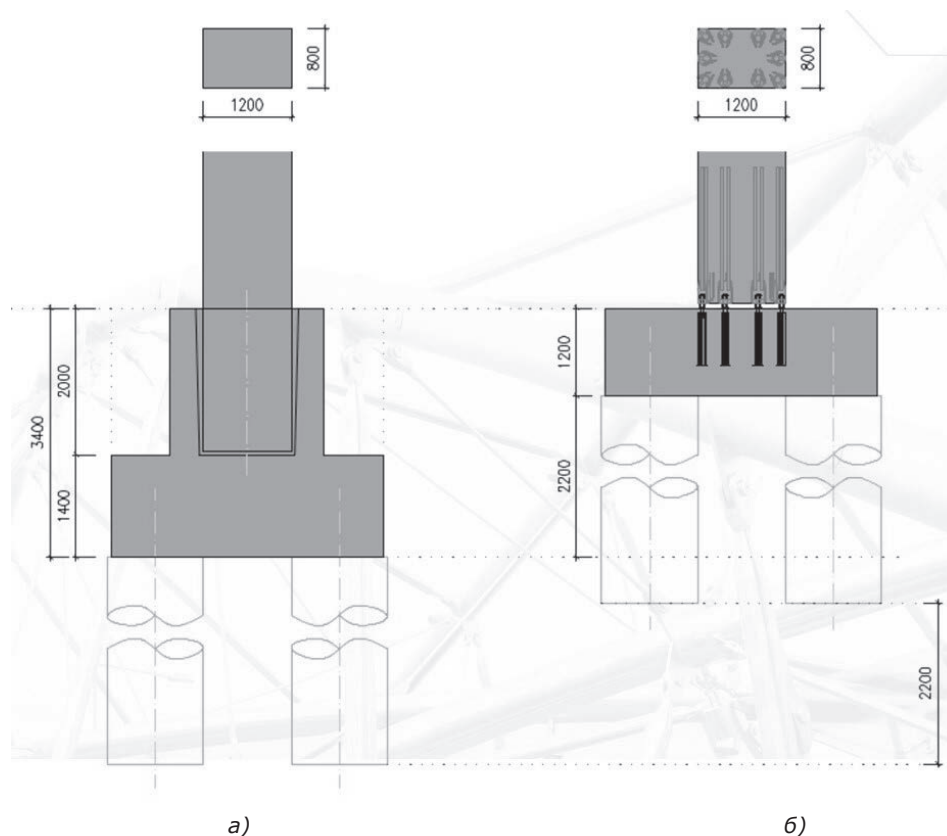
Схеми конструктивних рішень вузла з'єднання колони з фундаментом:
